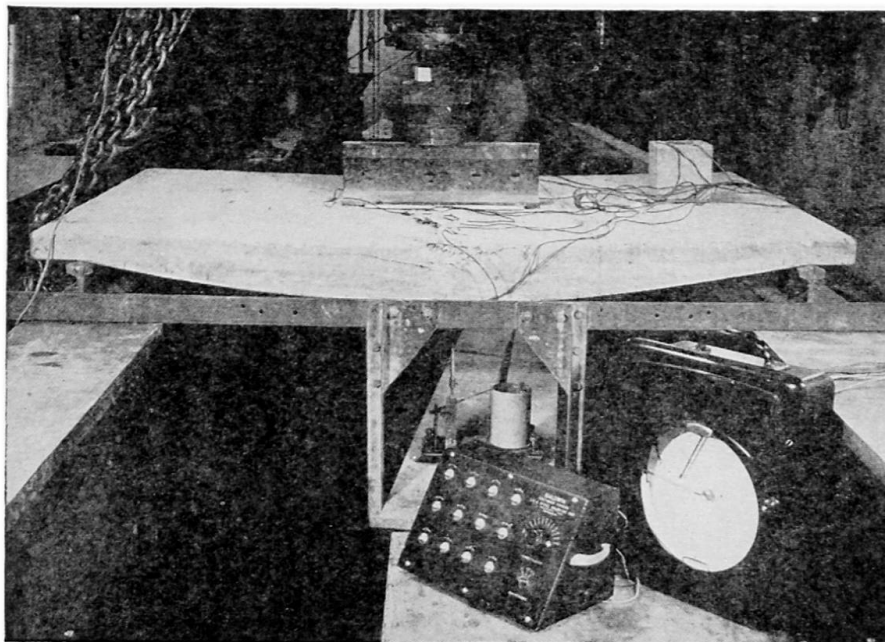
Vue d'ensemble du dispositif d'essai—Rupture du panneau de 12 cm. dans l'essai de flexion
